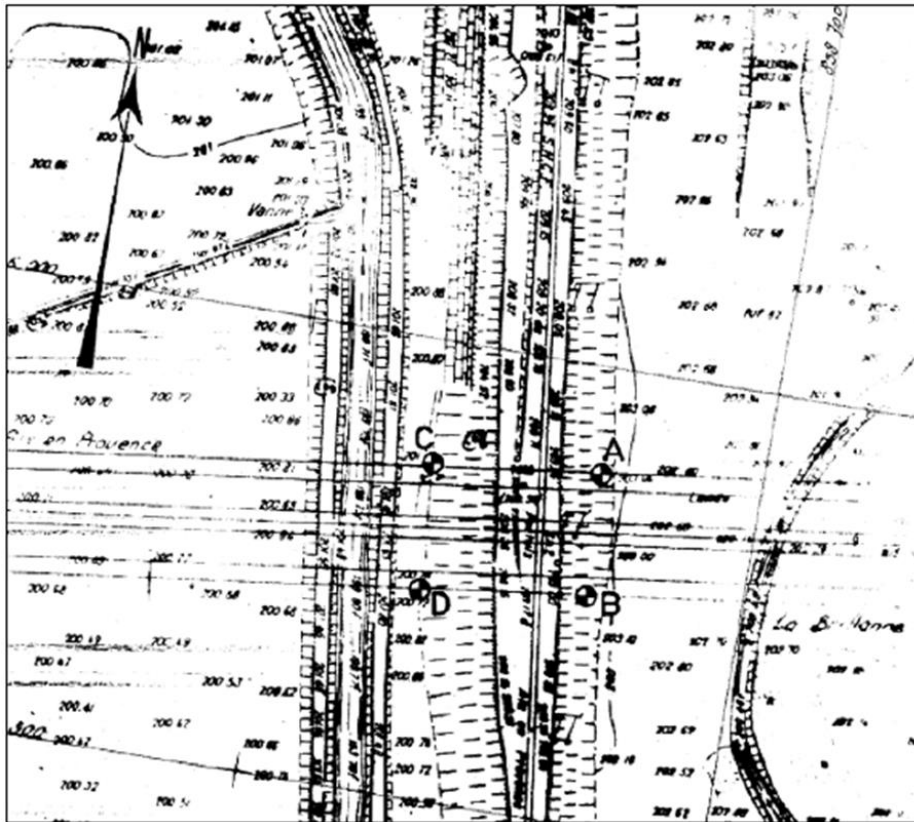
Plan d'implantation et habillage des sondages A à D sur profils en travers (source : BRGM)
